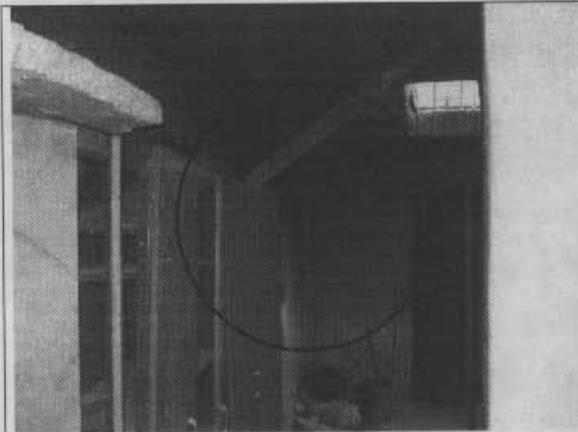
Agrietamiento de muros en algunos sectores al interior de la construcción.
